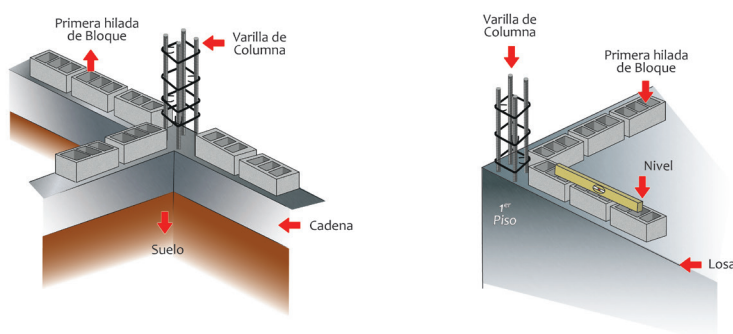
Colocación de primera fila de bloques sobre cadena o sobre losa
